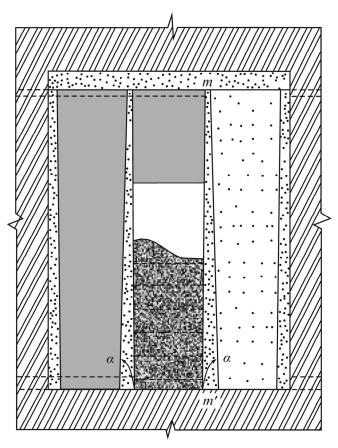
Общий вид каркасной конструкции с трапециевидными искусственными массивами (вертикальный разрез)
